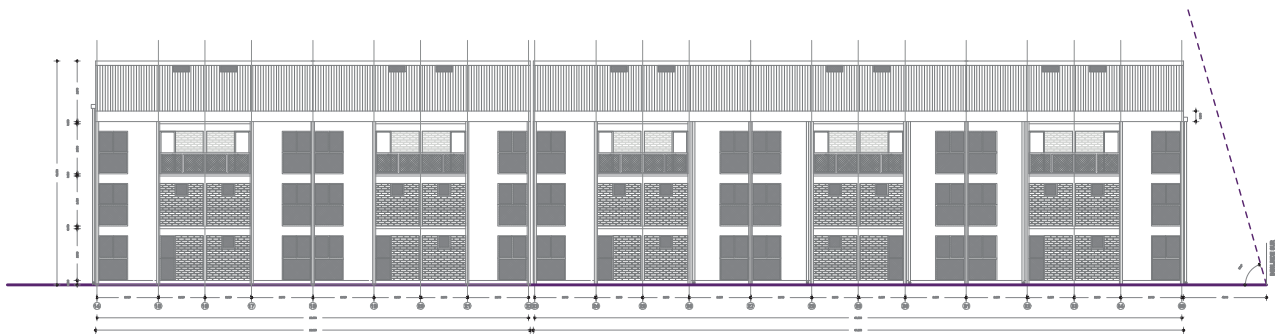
Elevación Norte Proyecto Ñuke Mapu en Base a Planimetrías. Sin Escala .Elaboración Propia
